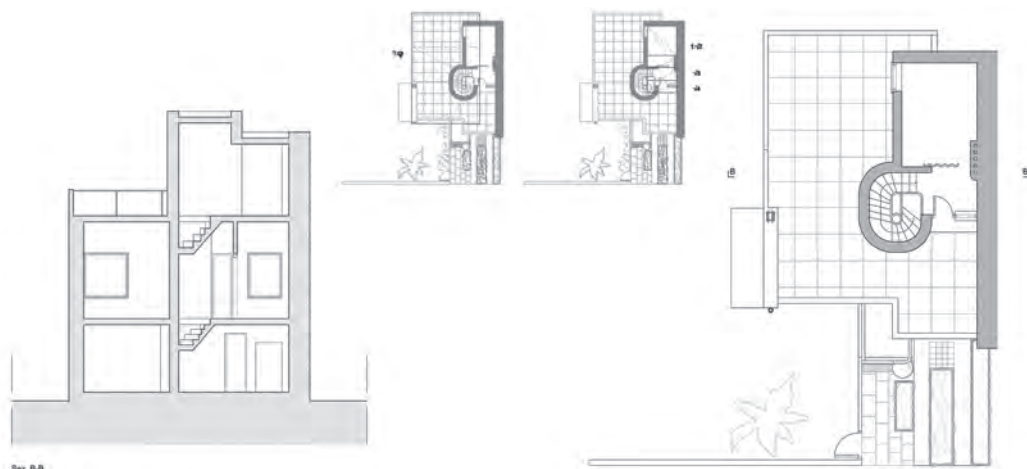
Ridisegno della pianta delle coperture, sezione trasversale e rapporti armonici.
